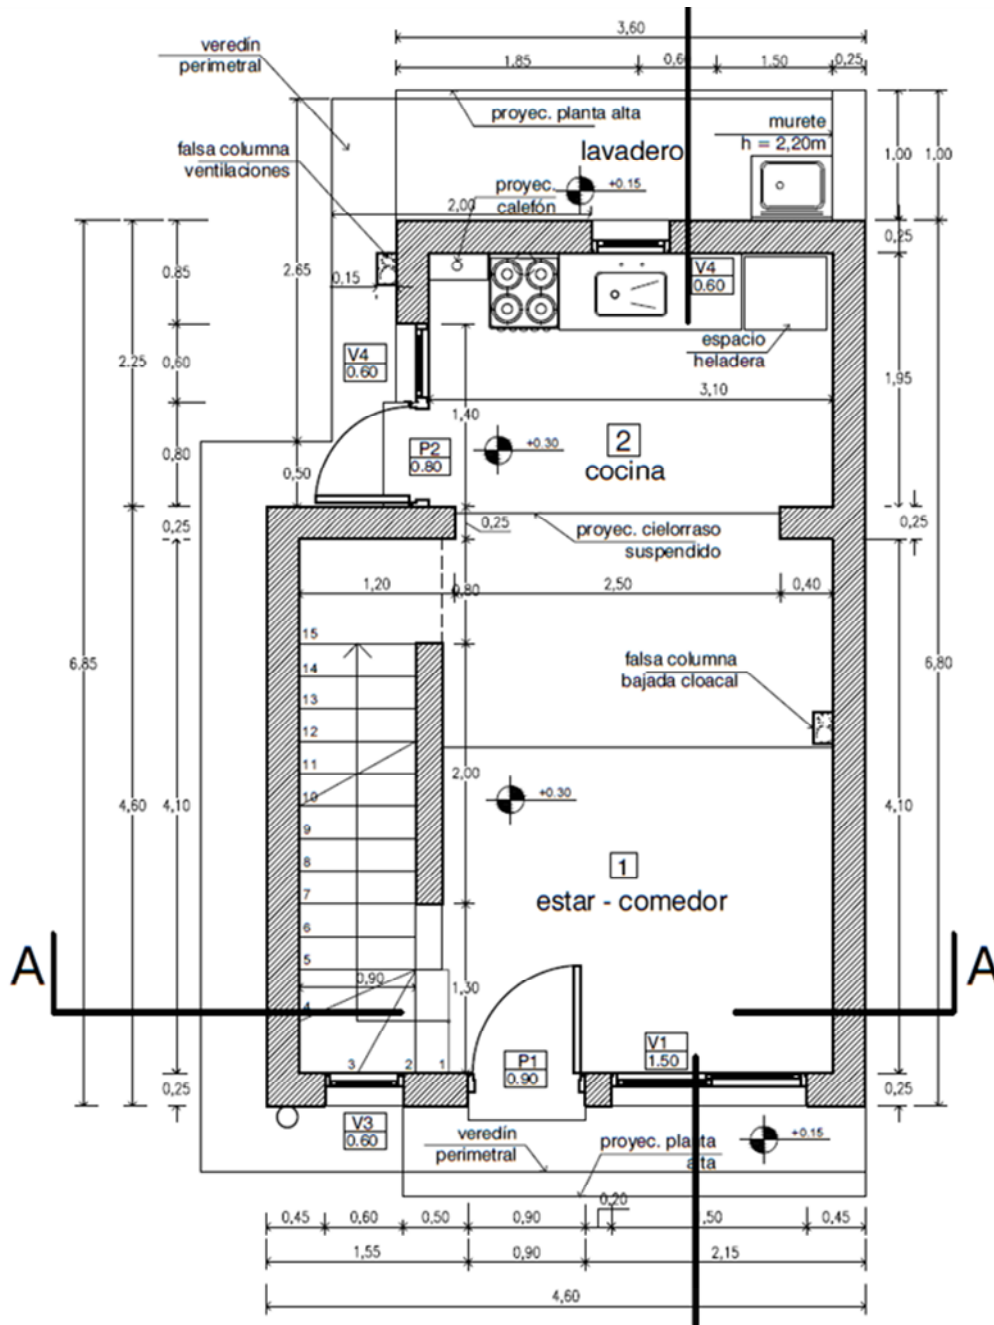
Planta baja de arquitectura de la vivienda de dos plantas.
